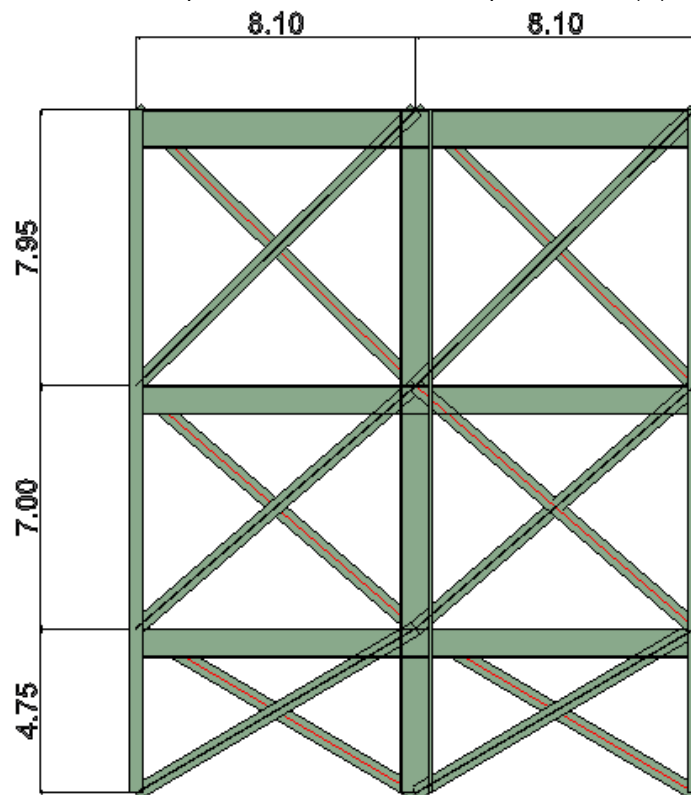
Elevación - Eje A y Eje C de la estructura de soporte del silo.
